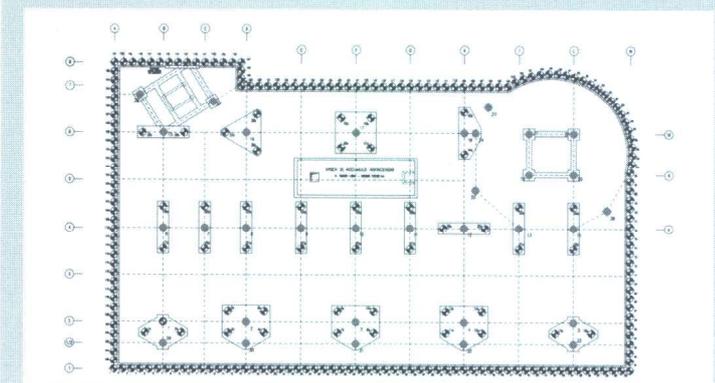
pianta della fondazione: i pali "colonna" retinati collegati ai pali "satellite" con i plinti
